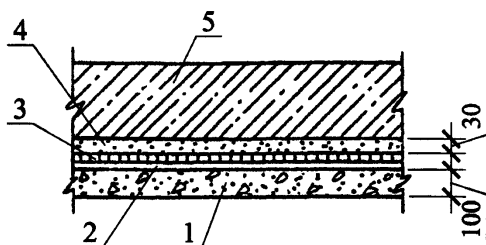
Узел 2. Асфальтовая гидроизоляция
